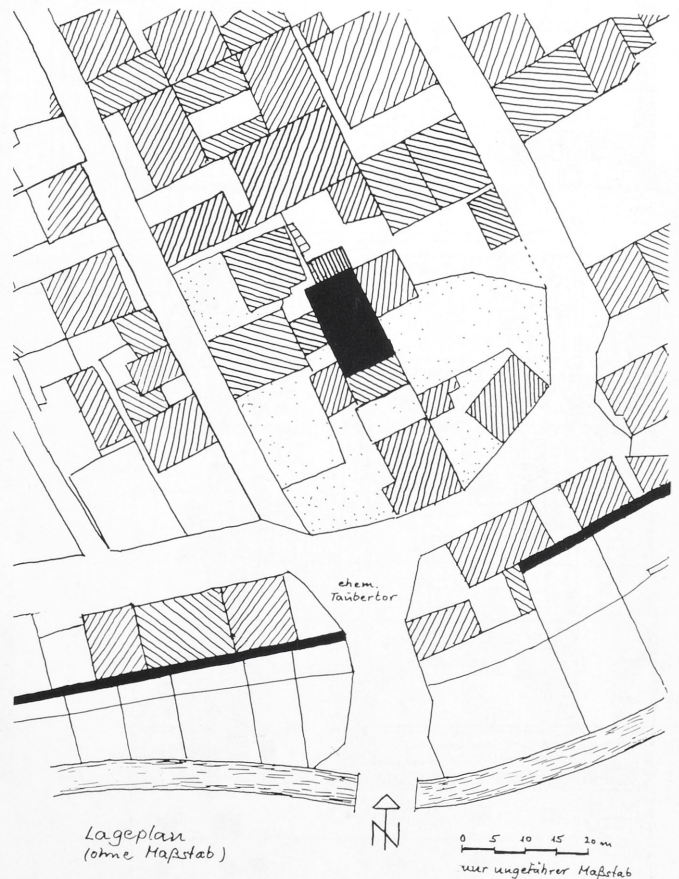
Lageplan in Anlehnung an Orts- und Katasterplan.
